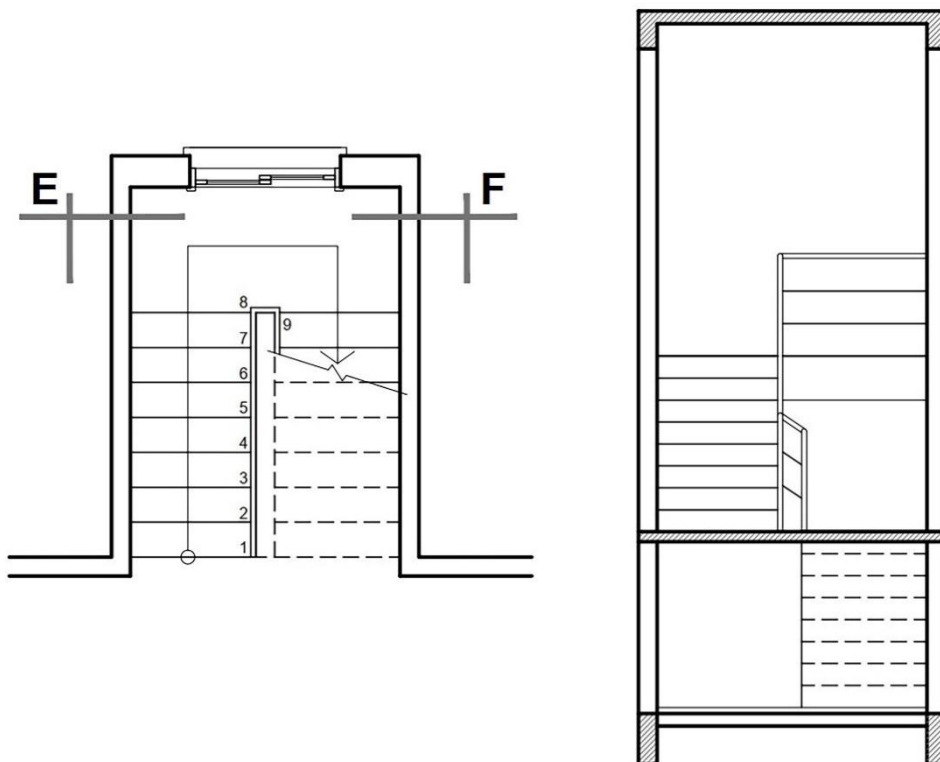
Alteração na posição do plano de corte: plano paralelo ao patamar. Fonte: autor
